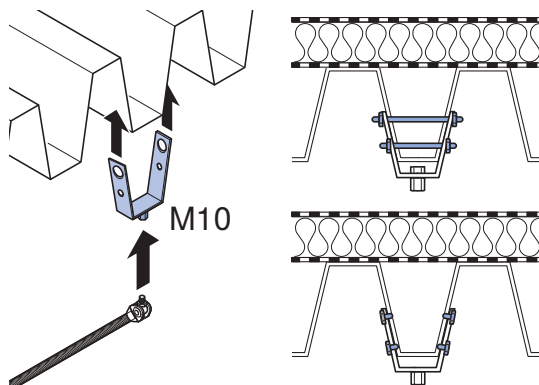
Fixation des kits de fixation de renfort Geberit Pluvia avec suspensions trapézoïdales sur une toiture trapézoïdale
